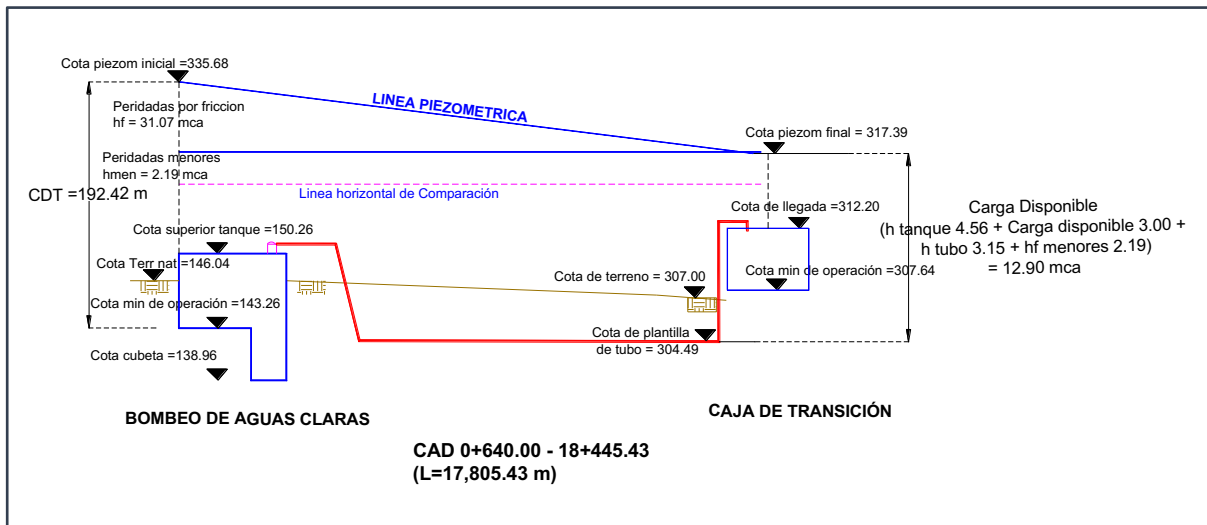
Piezométrica de la planta potabilizadora caja de transición Loma Prieta, Alternativa 2
